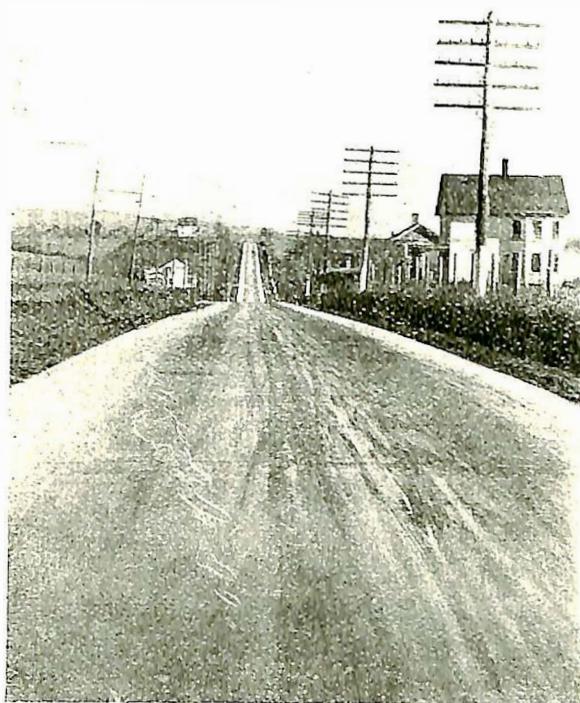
Betongvei Phillipsburg—Washington, New Jersey, bygget 1922.
